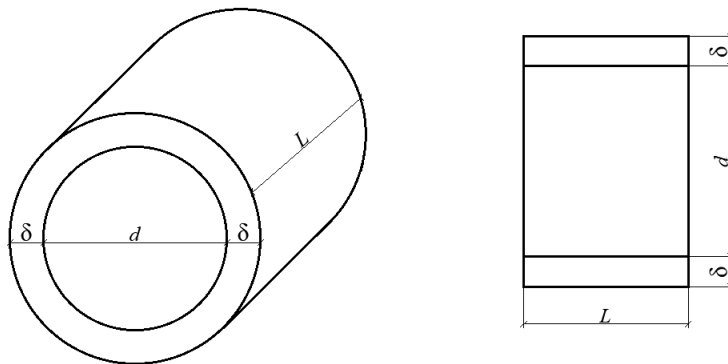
Цилиндрическое звено железобетонной безнапорной
